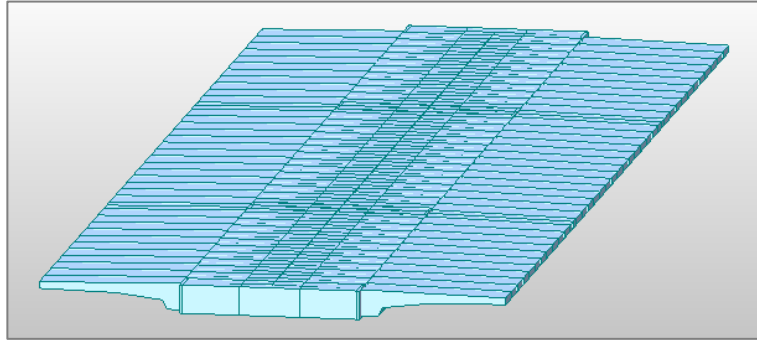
Modelo de puente losa con una longitud de 50 metros.
